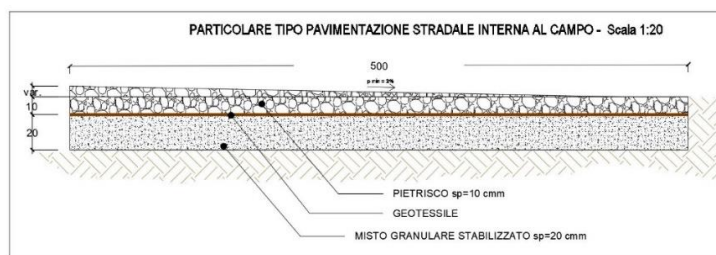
Particolare tipo pavimentazione delle viabilità di servizio interne.
